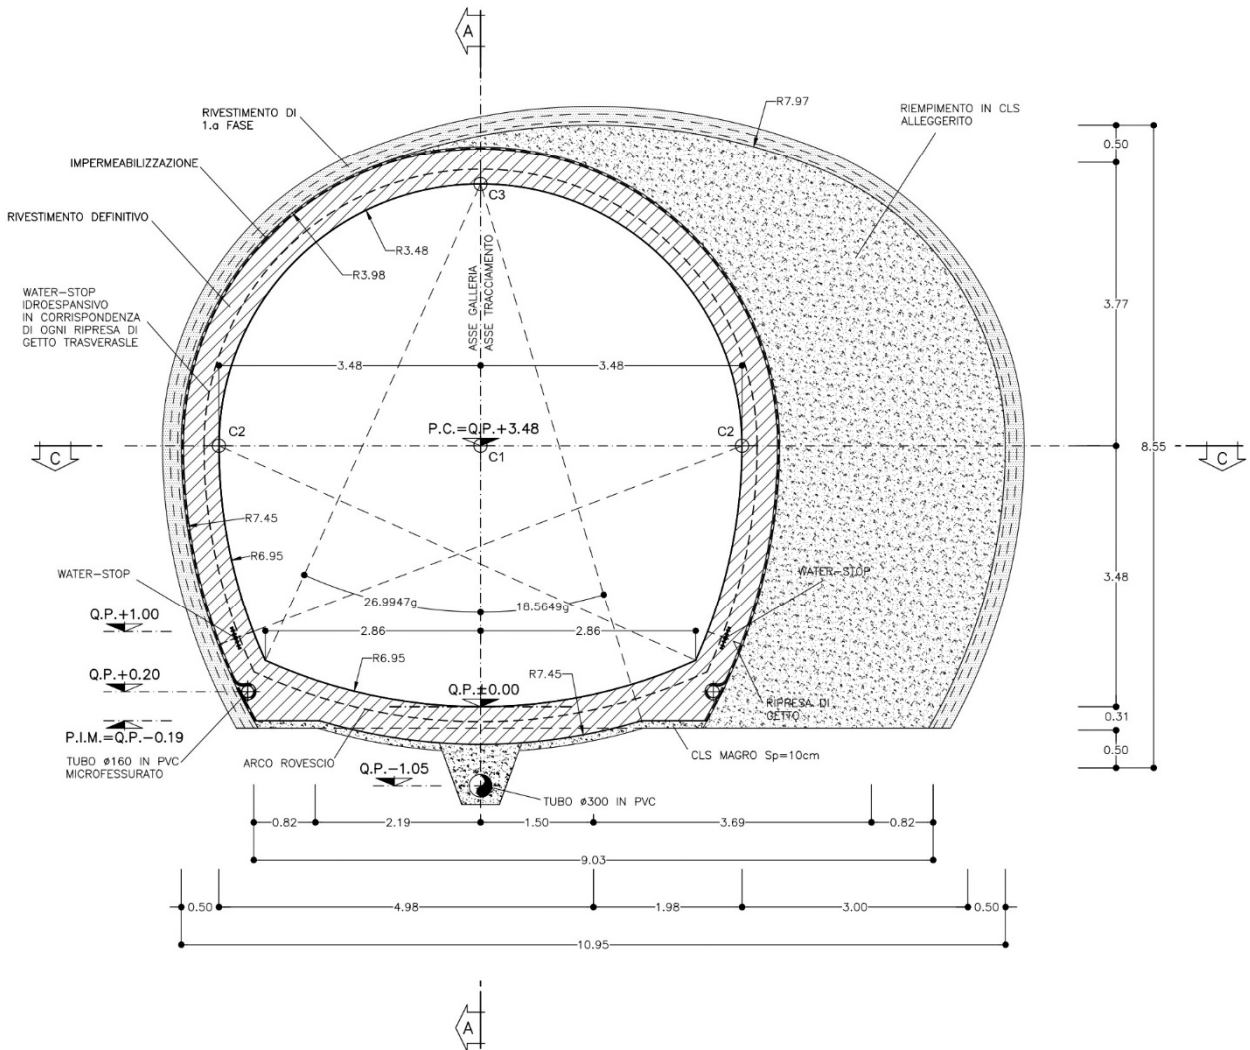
Sezione Tipo Ab “Allargata” – Carpenteria – Sezioni
